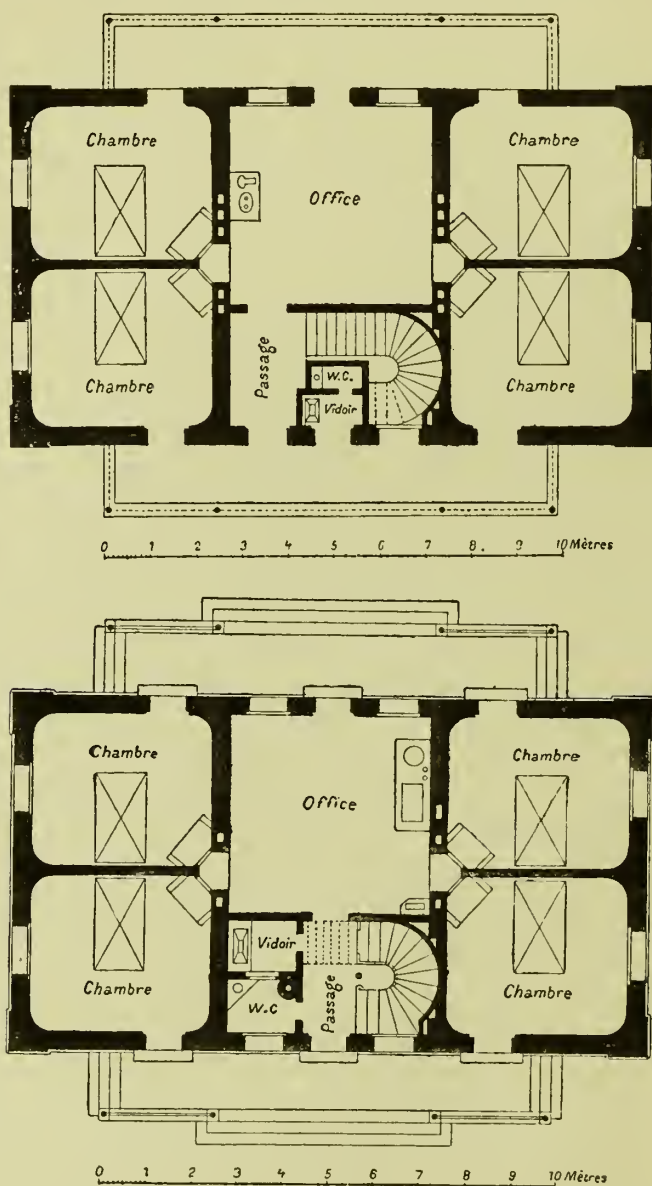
Coupes horizontales du pavillon d'isolement; la figure du haut représente la coupe du premier étage; la figure du bas la coupe du rez-de-chaussée.
